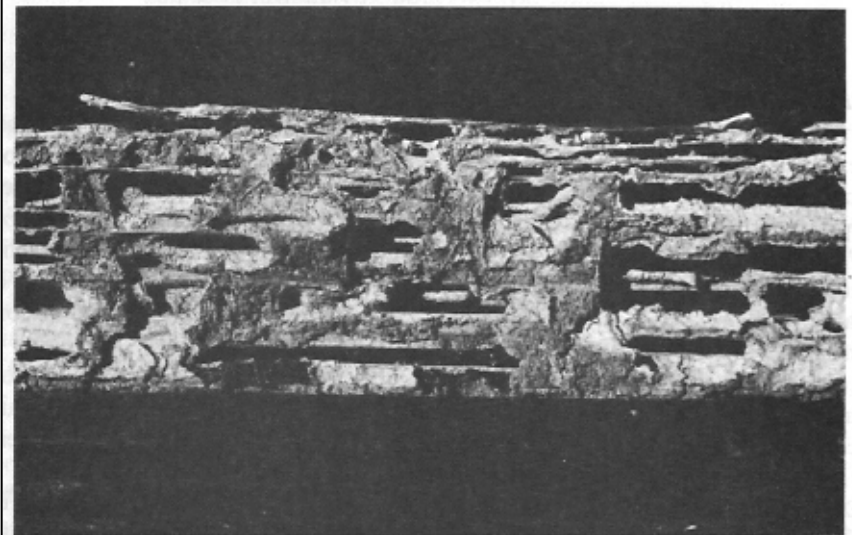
Aspetto dell'interno di un travetto di Abete attaccato dalle Termiti (Foto Giordano, 1970).
